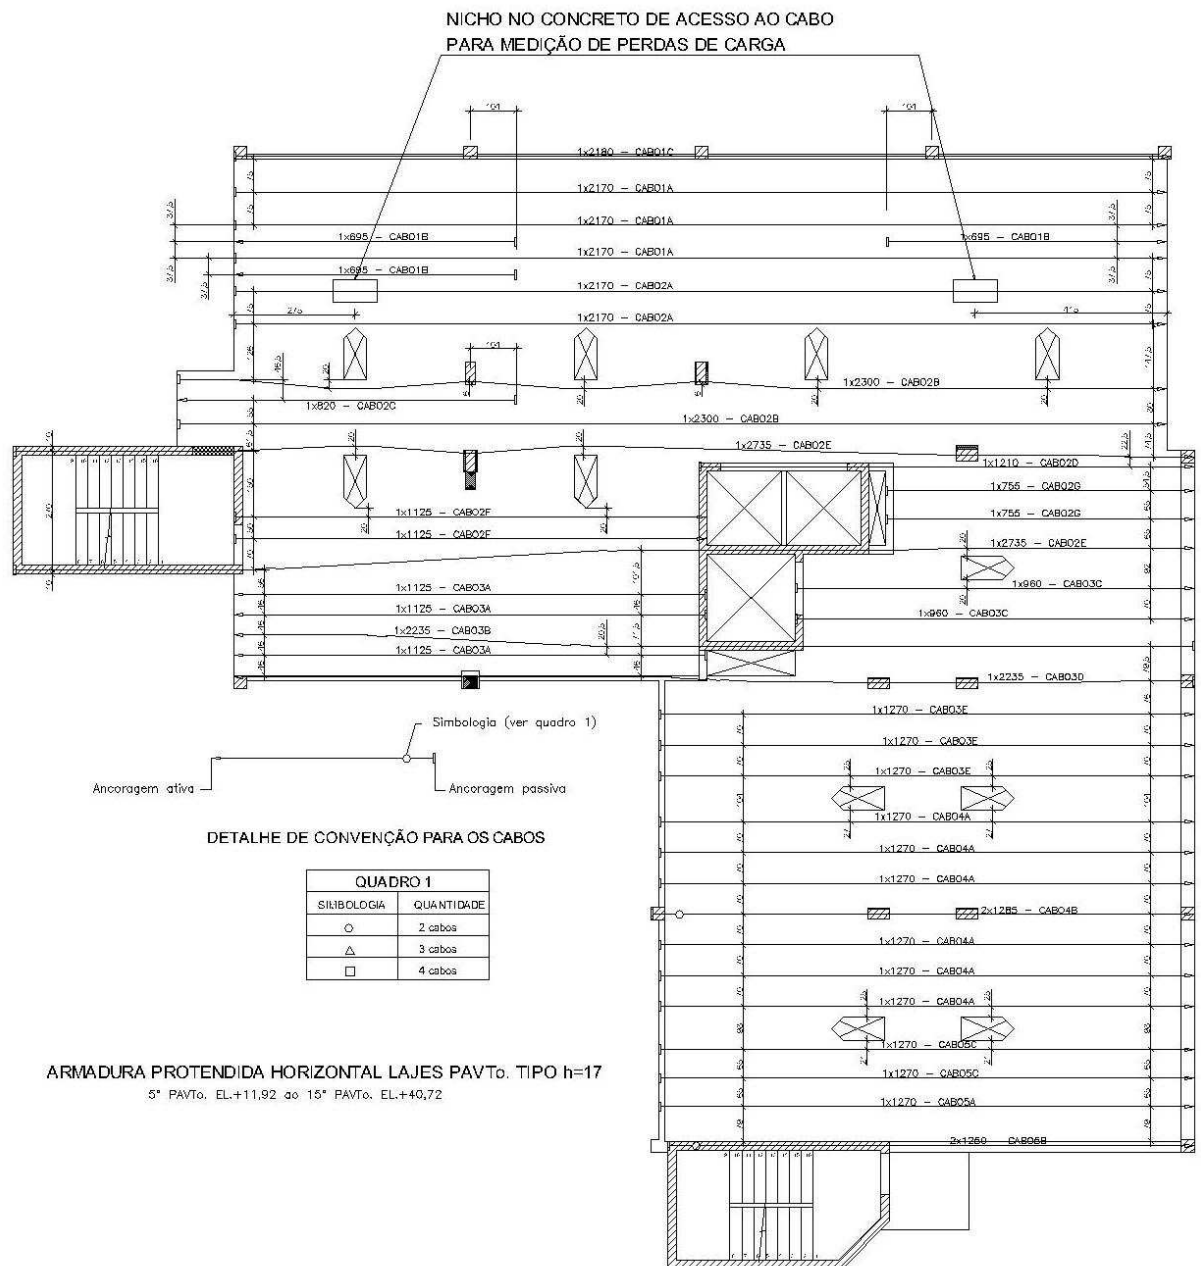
Planta de distribuição horizontal das cordoalhas no pavimento tipo
